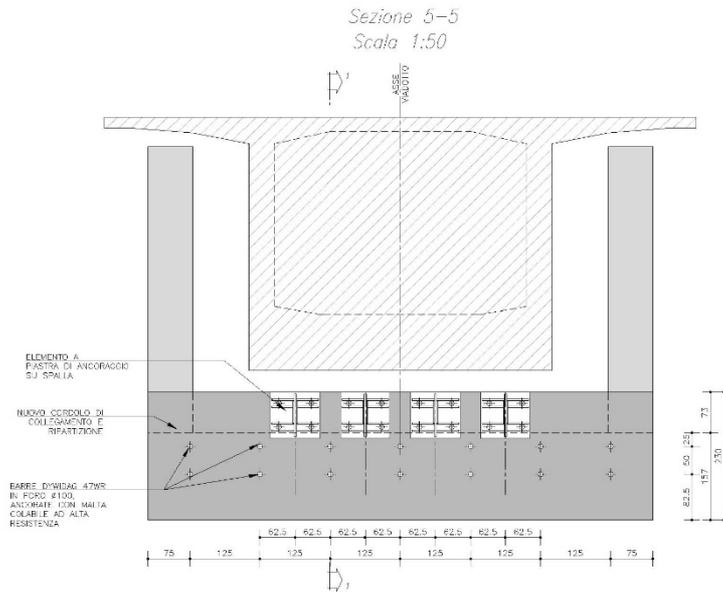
SP.3 - Sezione trasversale in asse appoggi (allineamento lato Torino)
